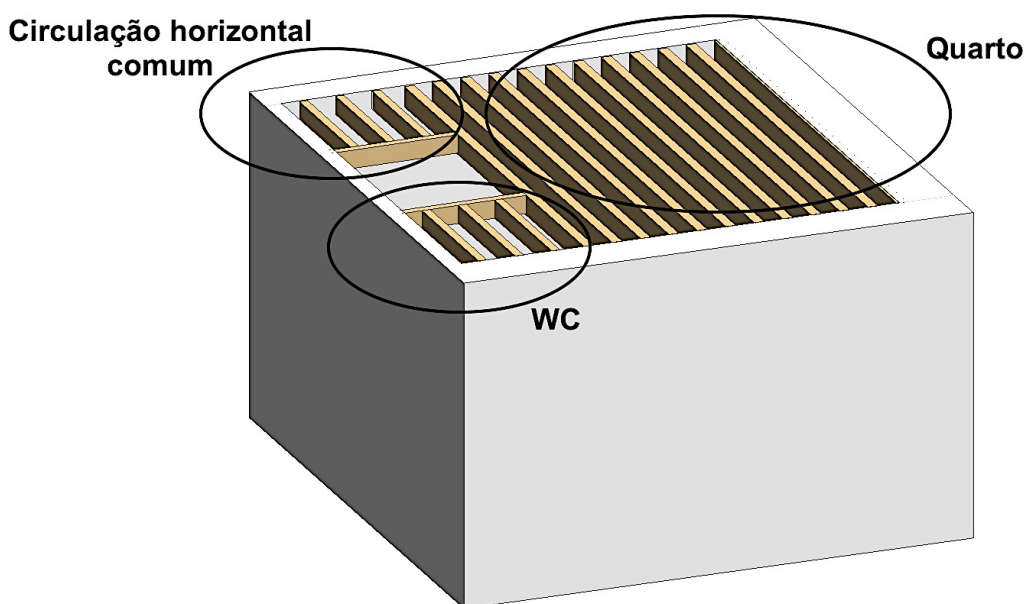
Modelação em Revit do novo pavimento (vigamento) da divisão a Norte, lado nascente.
